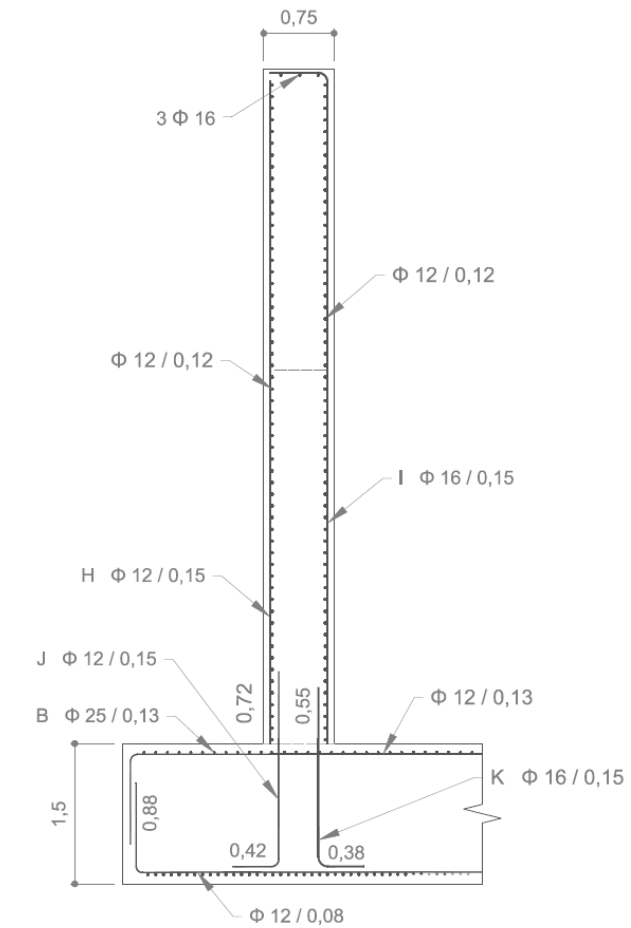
ARMADO DE LA ALETA TRANSVERSAL DEL ESTRIBO 1
